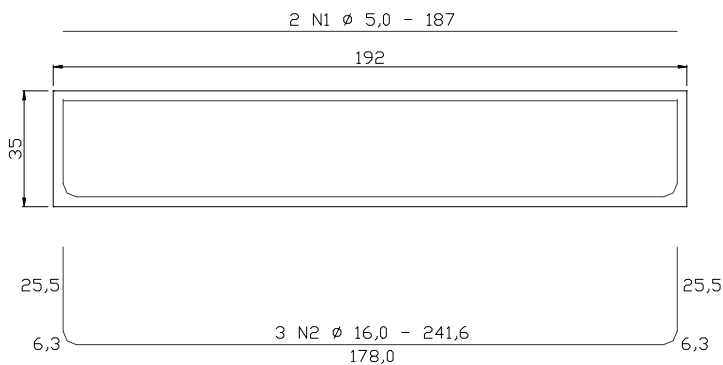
Detalhamento das armaduras das vigas do grupo VS (cotas em cm)
